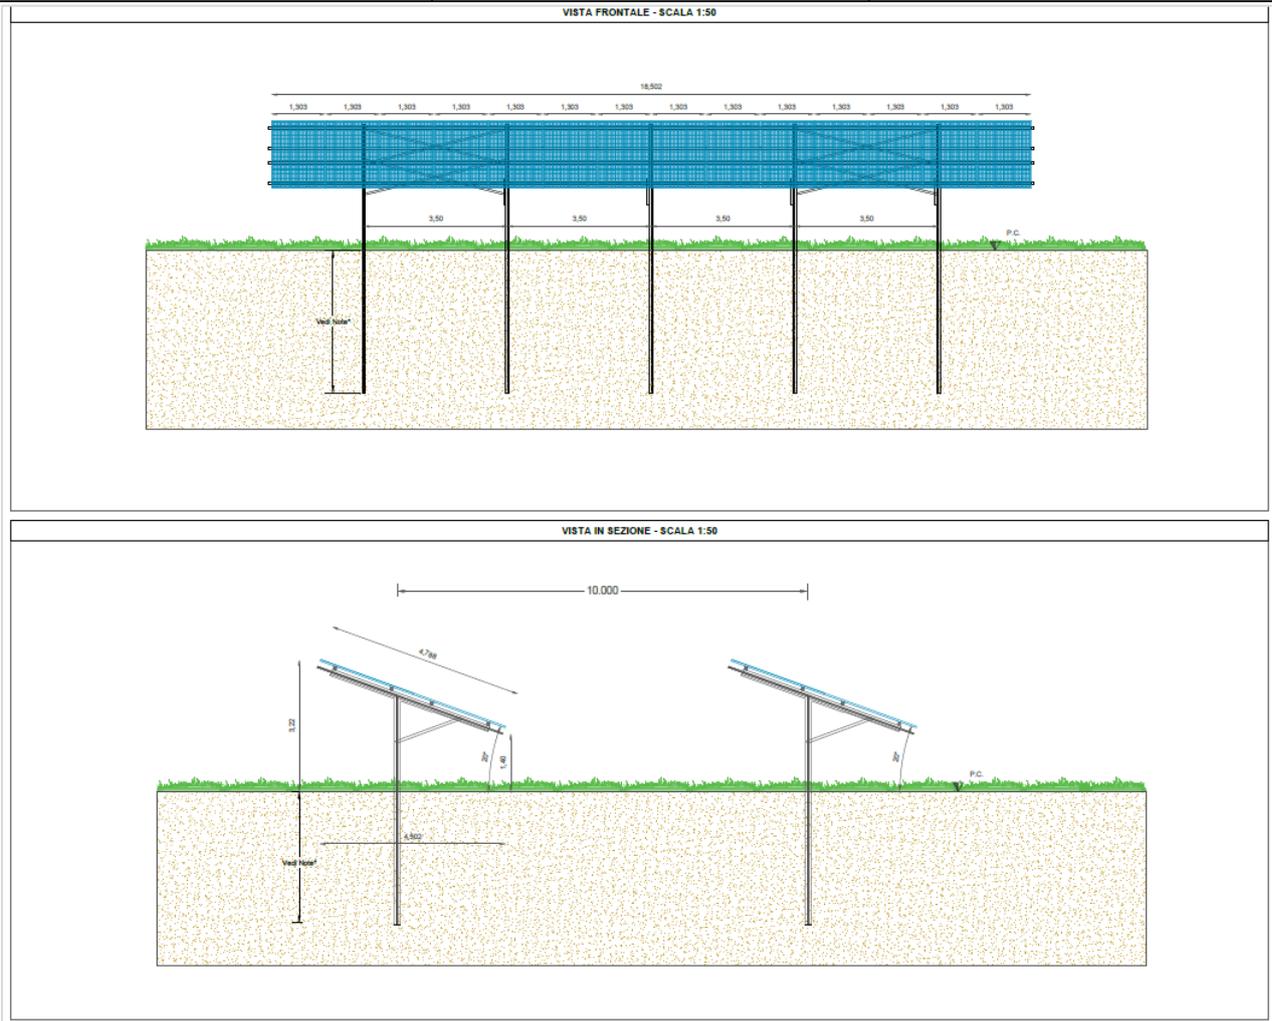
Stralcio elaborato "CEN.ENG.TAV.032.00_DISEGNI DELLE STRUTTURE DI SOSTEGNO E DELLE OPERE DI FONDAZIONE"
